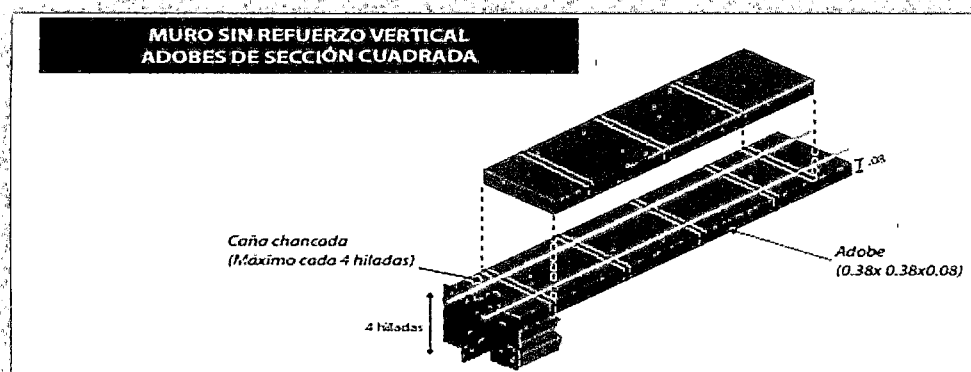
Muro sin refuerzo vertical adobes de sección cuadrada.
